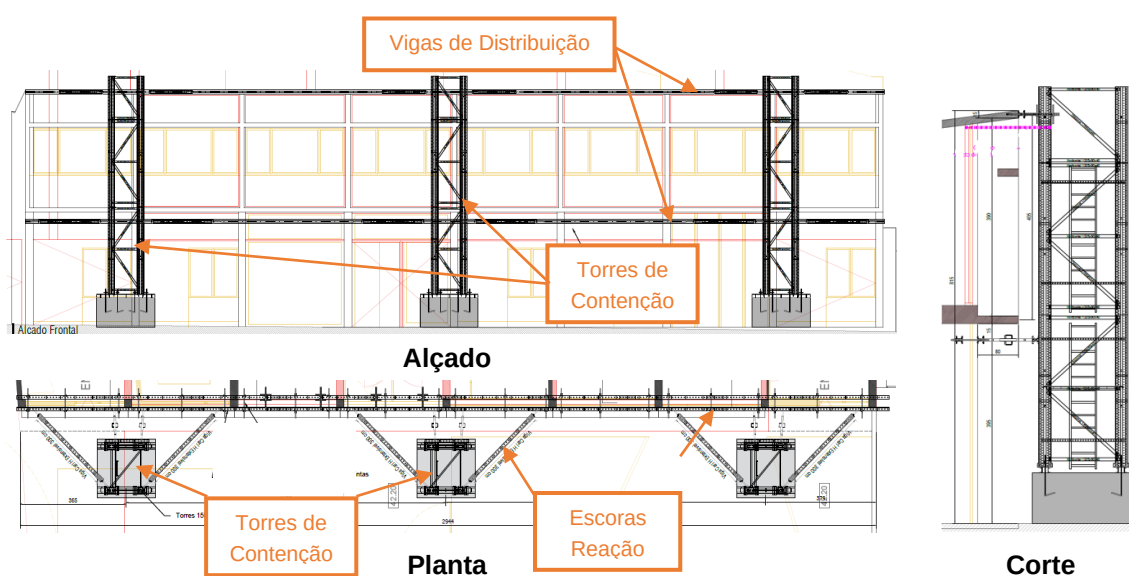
Solução de contenção de fachada desenvolvida: Corte, Alçado e Planta
